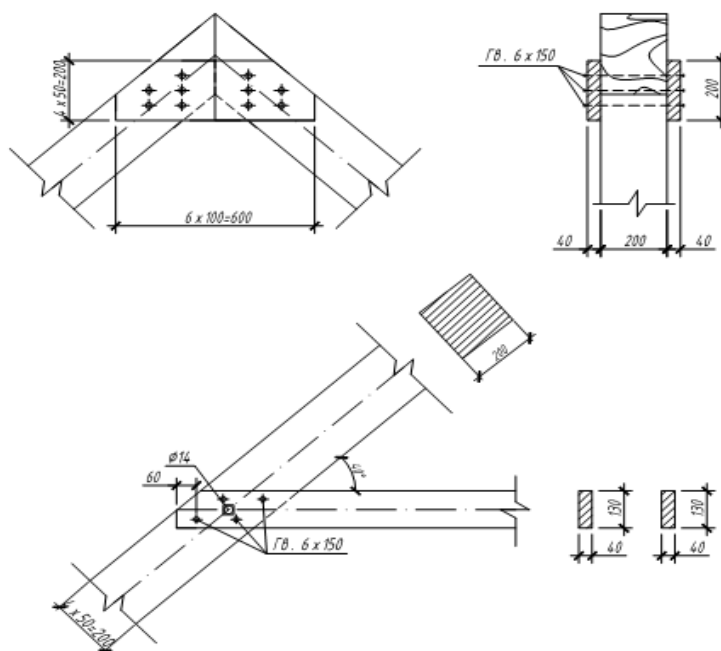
Узлы соединения верхнего пояса арки и ригеля с ним
